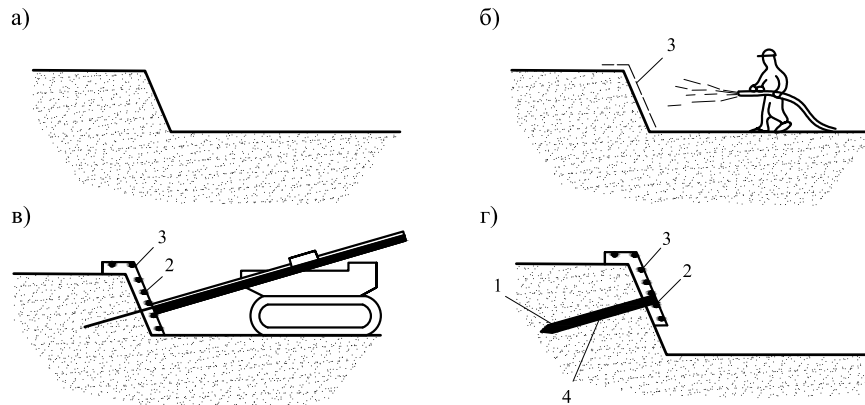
Технологічна послідовність нагельного способу горизонтального армування природного ґрунтового масиву: а, б, в, г – послідовність робіт; 1 – стержнева арматура; 2 – захисна стінка із торкретбетону або збірних плит; 3 – металева сітка для армування стінки; 4 – заповнення свердловин зі стержнями цементним розчином
